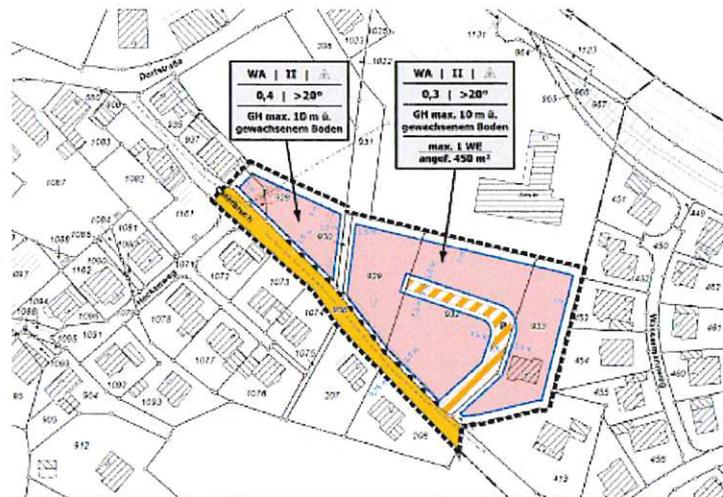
Änderungsbereich Bebauungsplan Nr. 47
